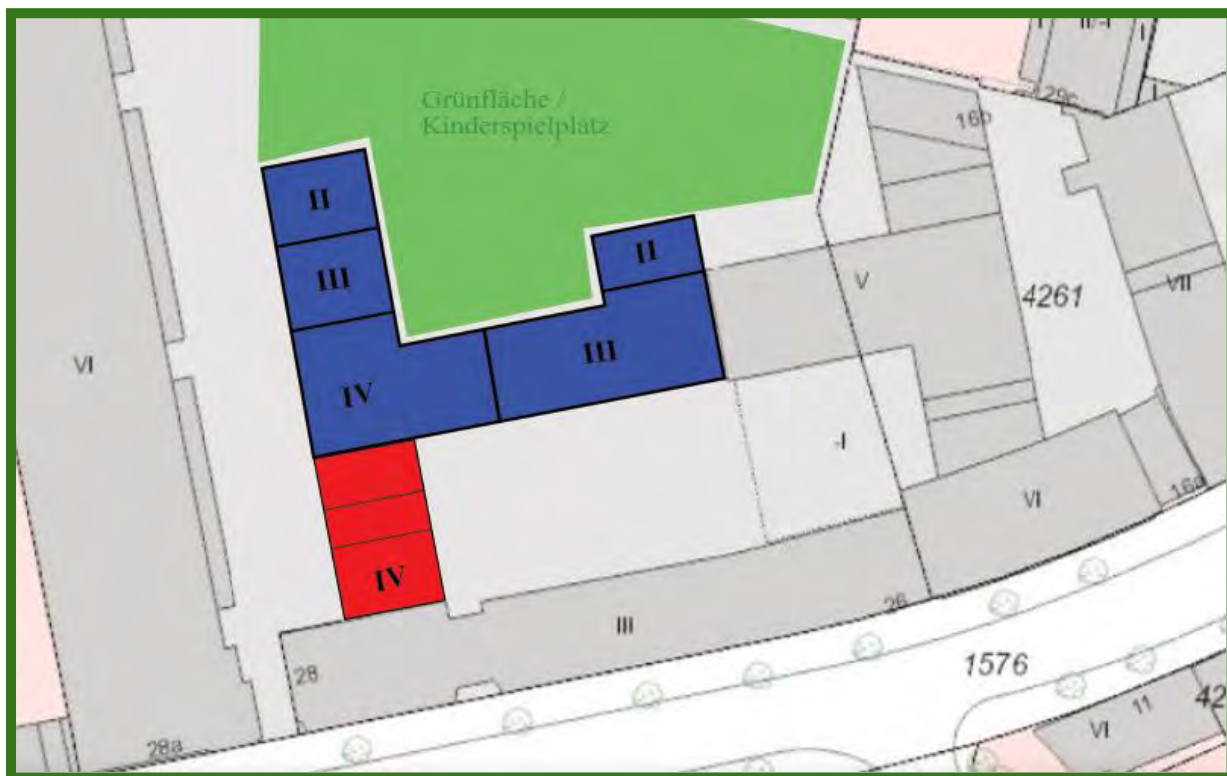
U-förmiger Neubau mit 3 Vollgeschossen und Staffelgeschoss
